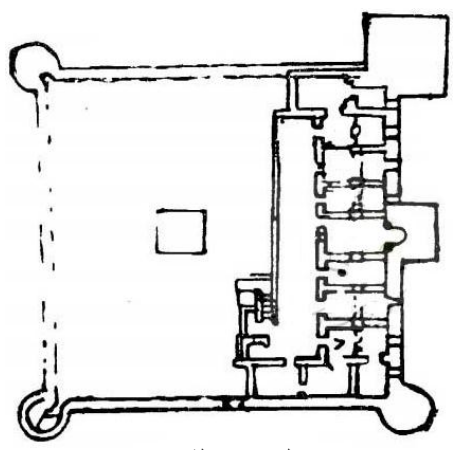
مسقط أفقي لجامع الزيتونة بتونس.
